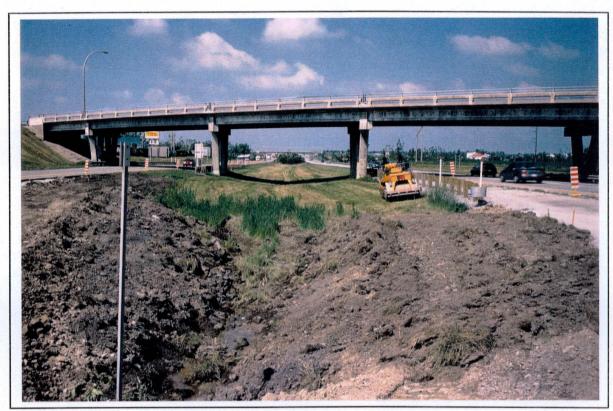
Projet 5372-9209 Autoroute 20, secteur 1, St-Hyacinthe (O)
